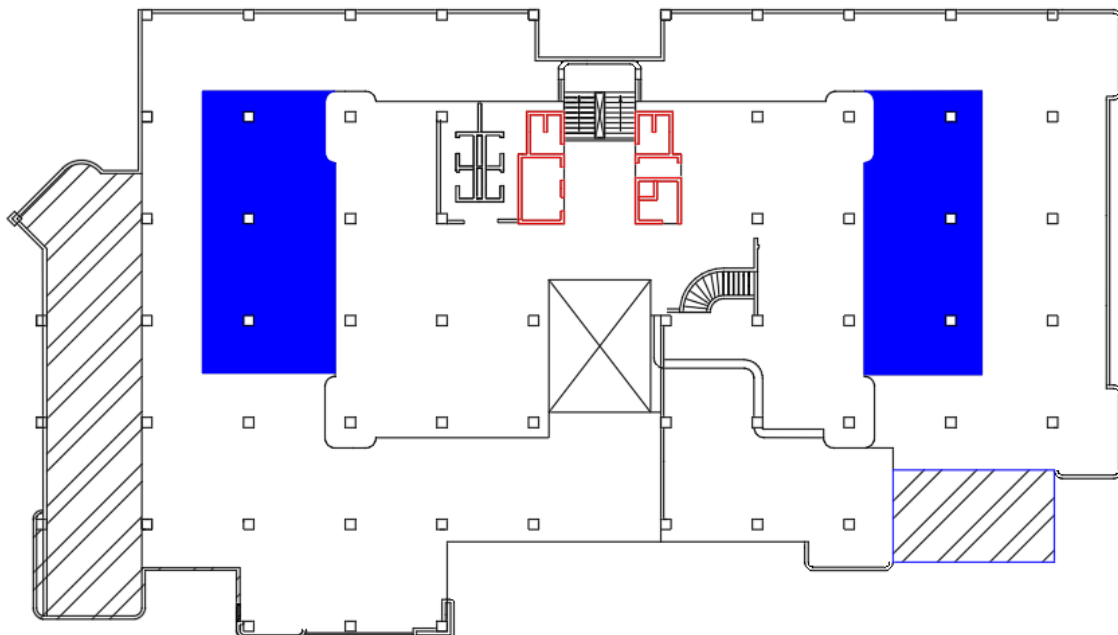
Esquema en planta de la Primera Planta del EERCs.
